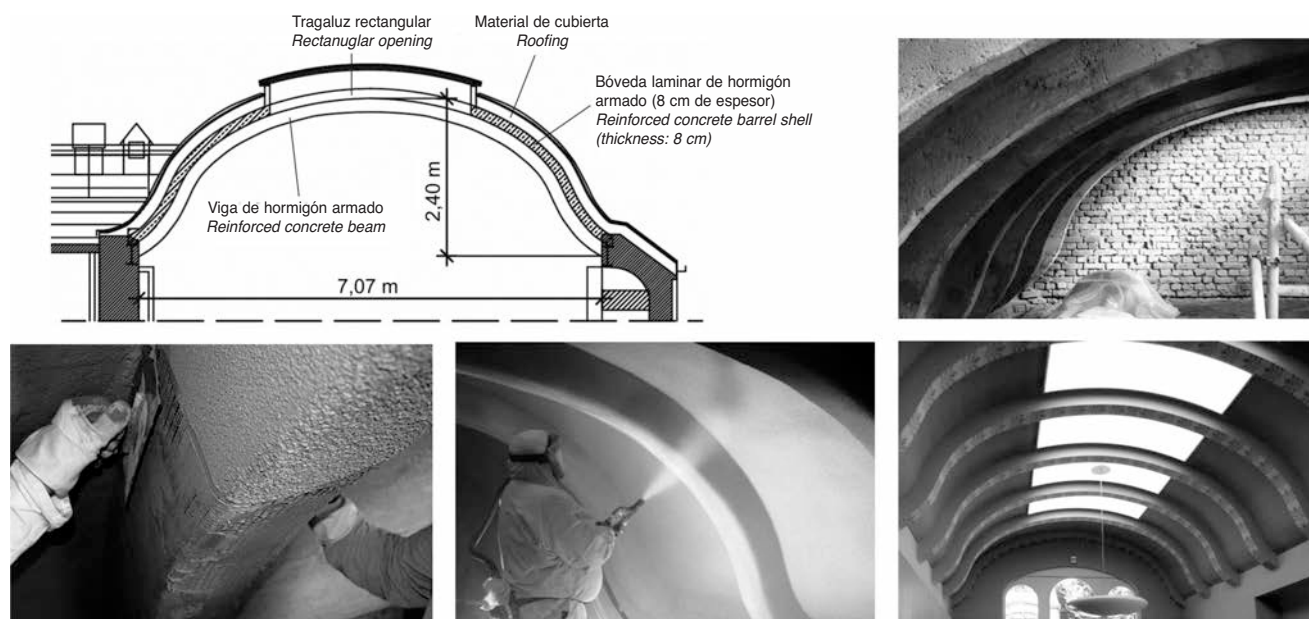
Sección transversal de la estructura, bóveda dañada antes, durante y después de los trabajos de refuerzo [52]
